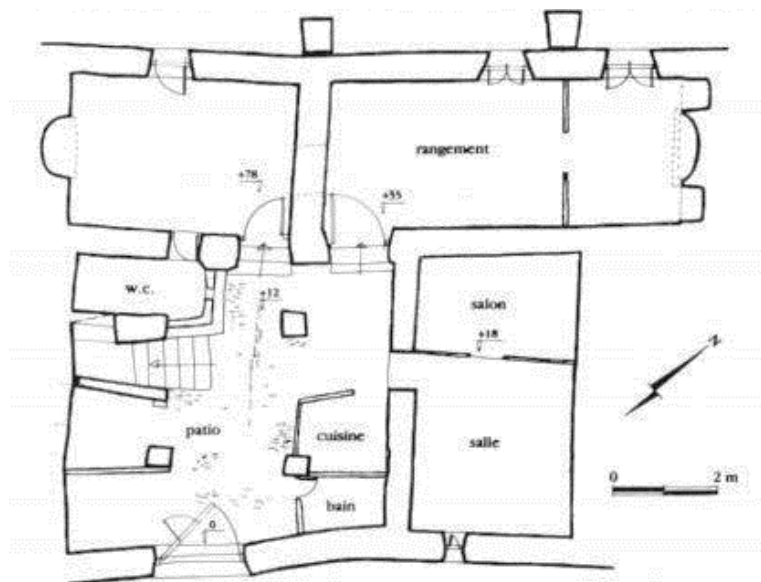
Plan de rez-de-chaussée d'une maison de Guájar Fondón
